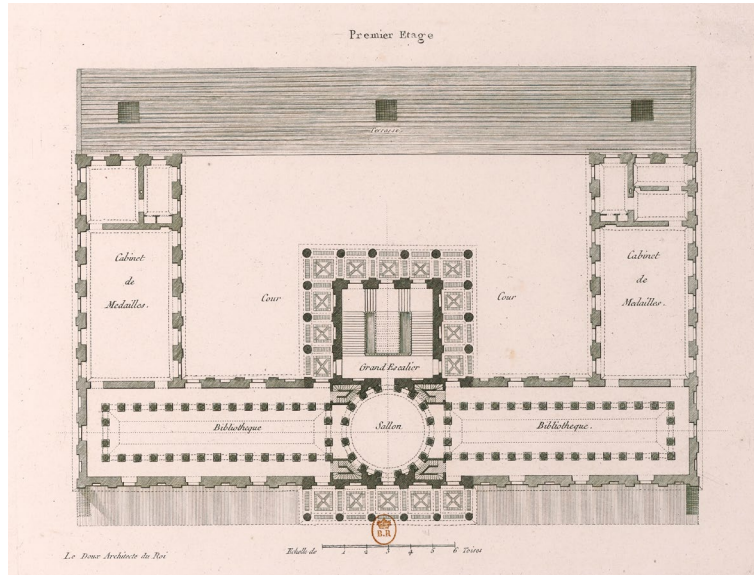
Claude Nicolas Ledoux, Grundriss des 1. Obergeschosses für die »Bibliothèque de Cassel«, um 1779. Der Entwurf zeigt einen vierflügeligen Museumsbau mit Modellsaal, der im ersten Obergeschoss mit einer Terrasse und drei Oberlichtern abschließt.
